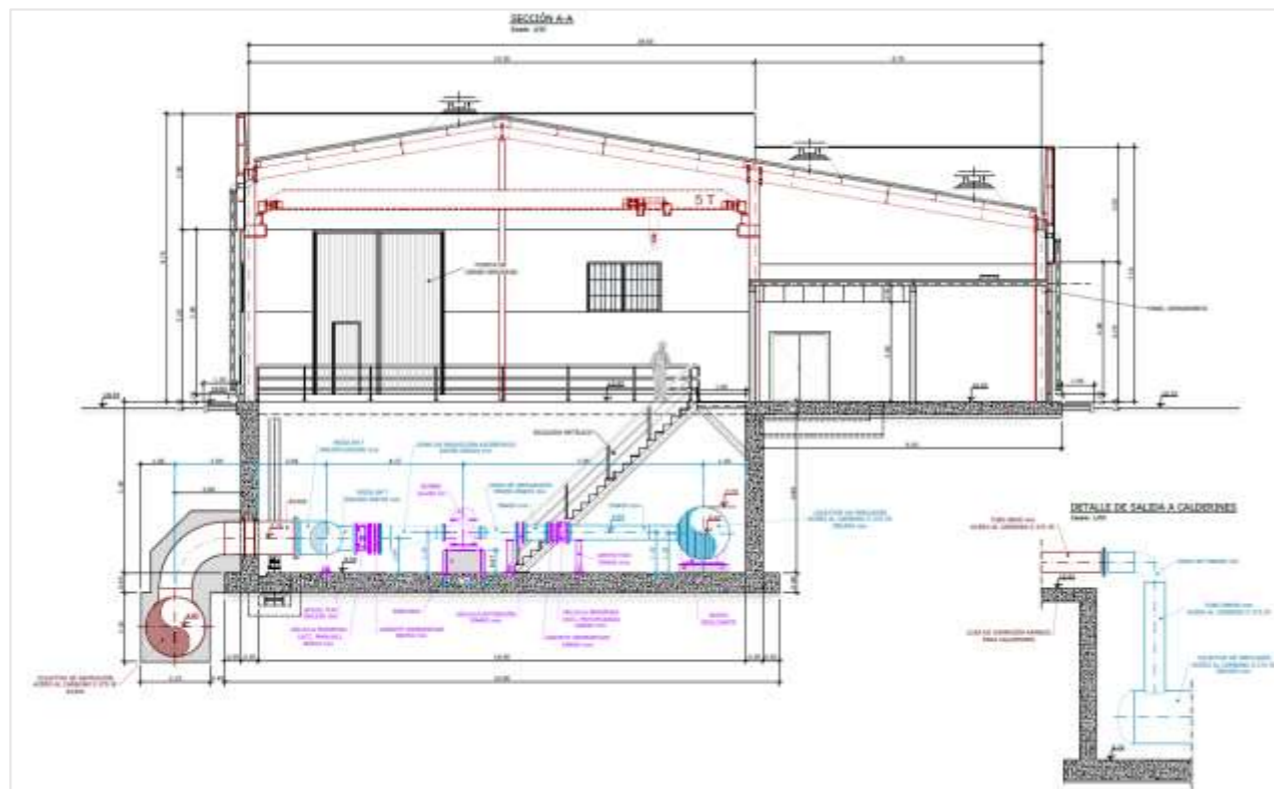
Sección transversal situación proyectada. Estación de bombeo del sector Alcantarillas
